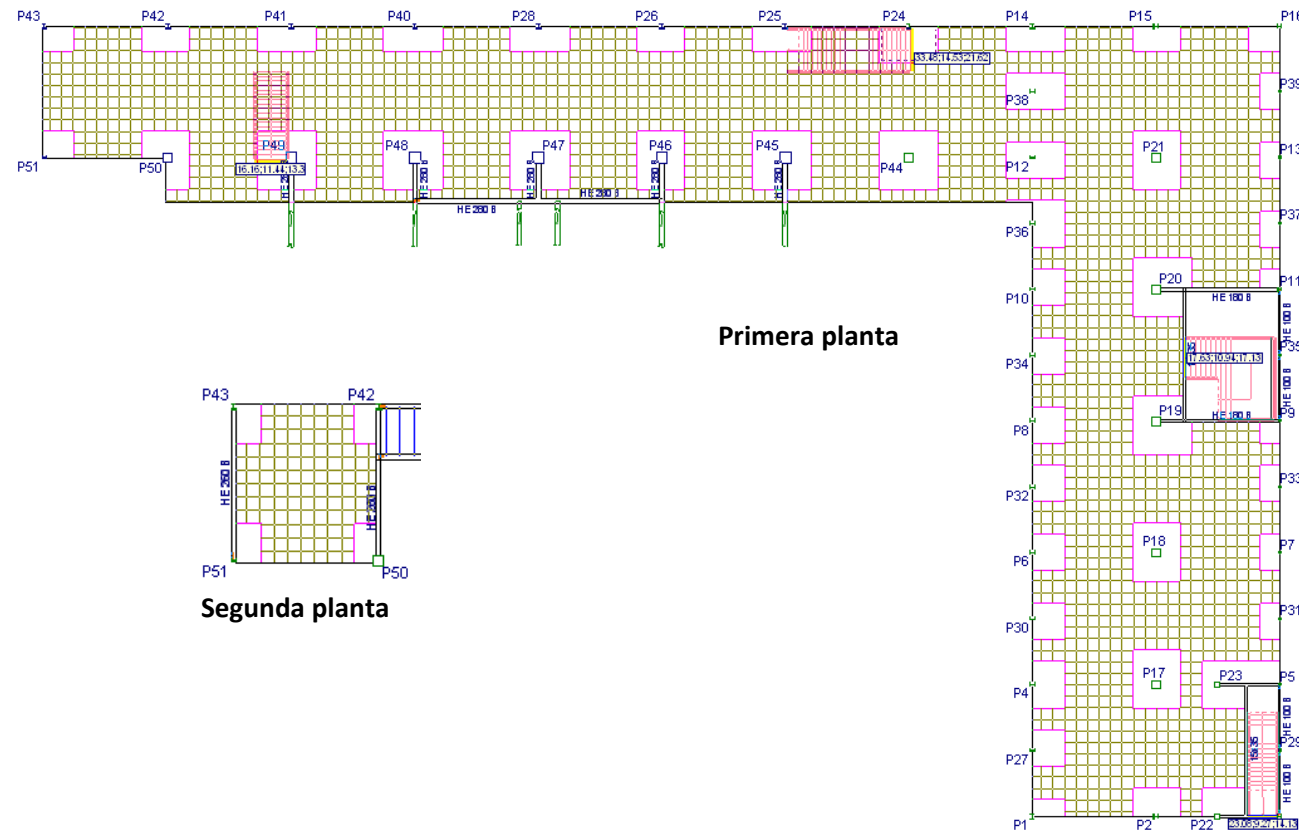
Disposición en planta del forjado reticular. Fuente: Propia
